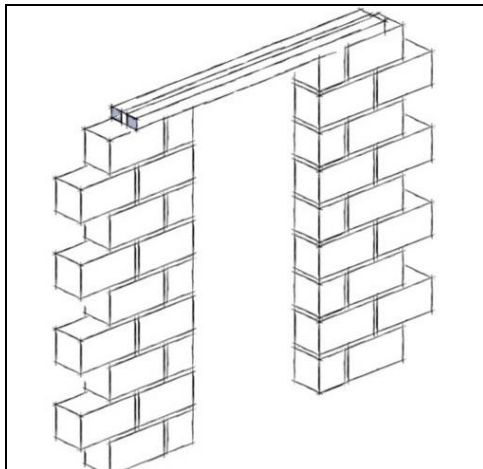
Muro de carga de una vivienda en Marruecos.
